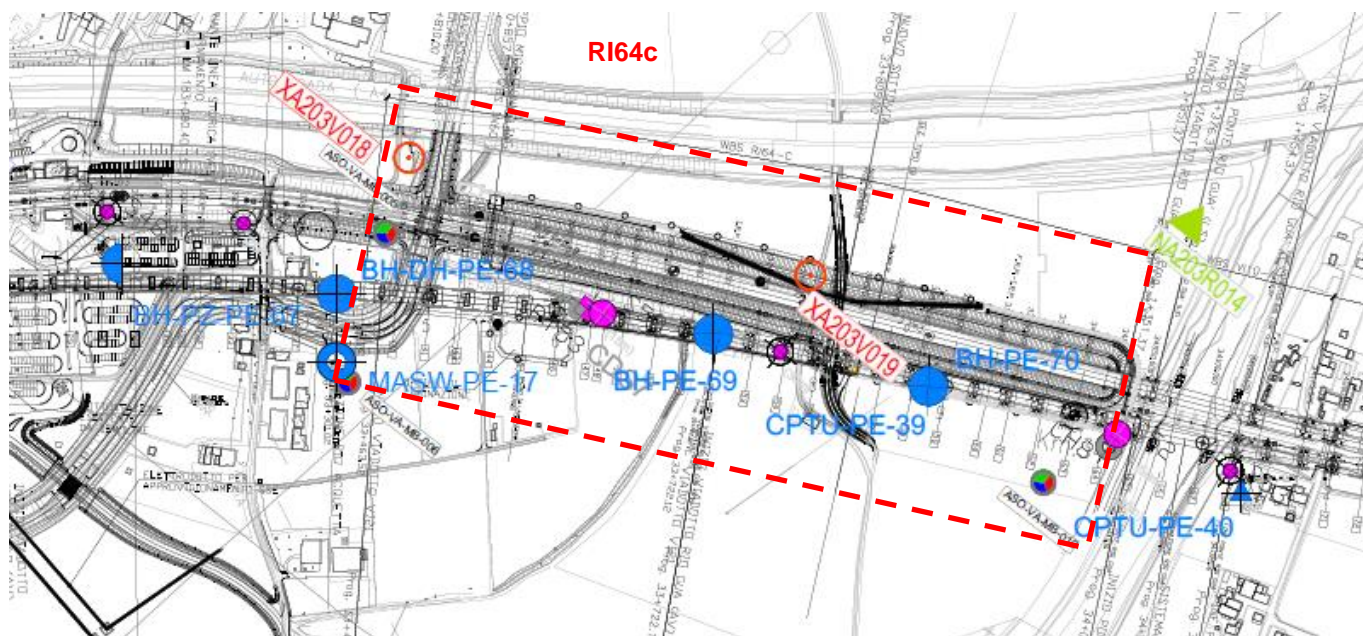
Planimetria Rilevato RI64c, estratto dalla Planimetria Generale (Doc. Rif.[6])
